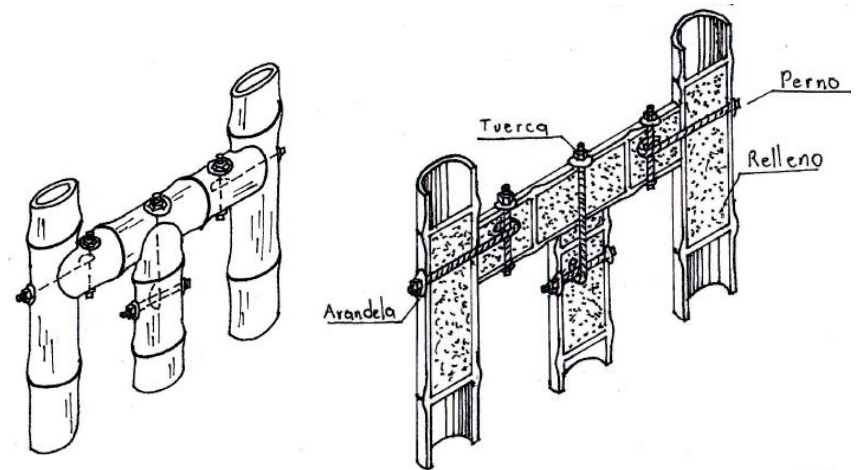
Detalle propuesto para la protección del elemento. Fuente: Elaboración propia.
